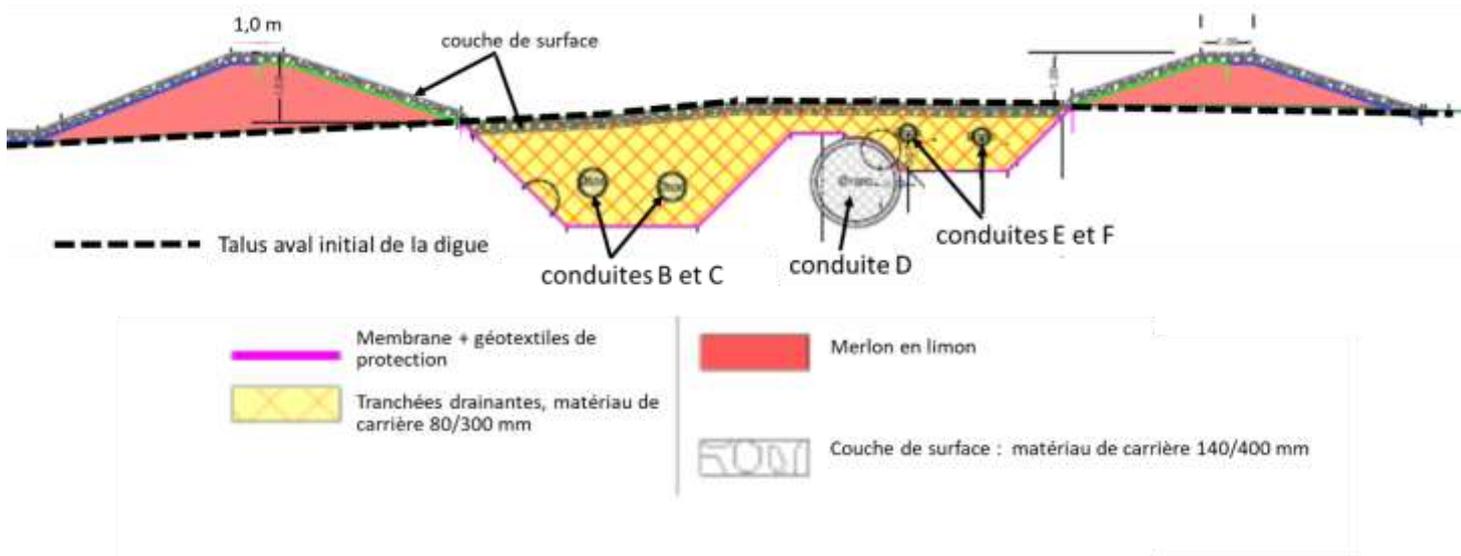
Coupe transversale du dispositif de protection, repérée sur la figure 1
